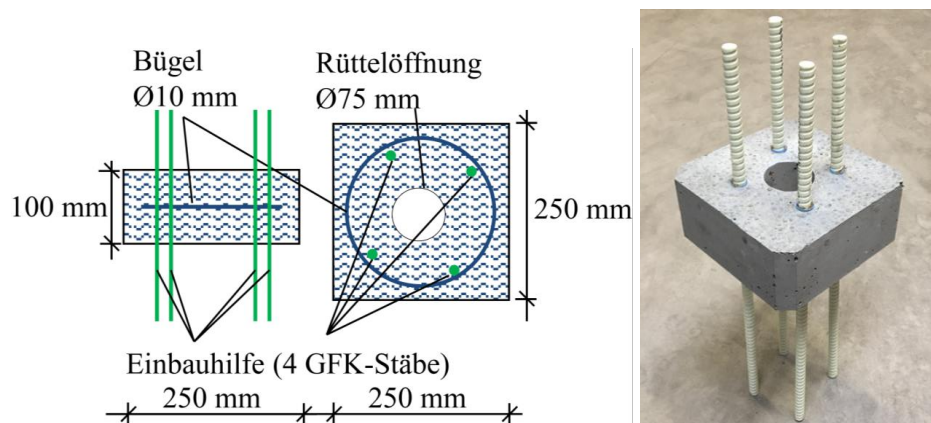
Darstellung des LC-Elementes (Geometrie, links und Element inkl. Einbauhilfe, rechts)
